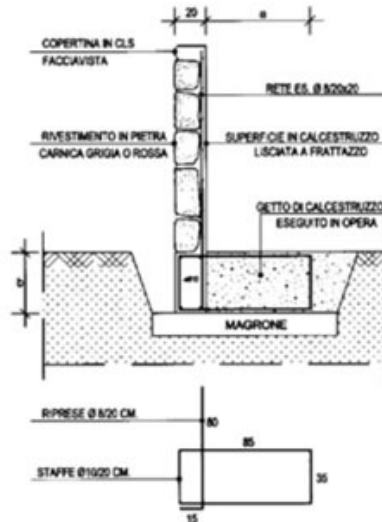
Sezione dei pannelli doppia lastra rivestiti in pietra.
